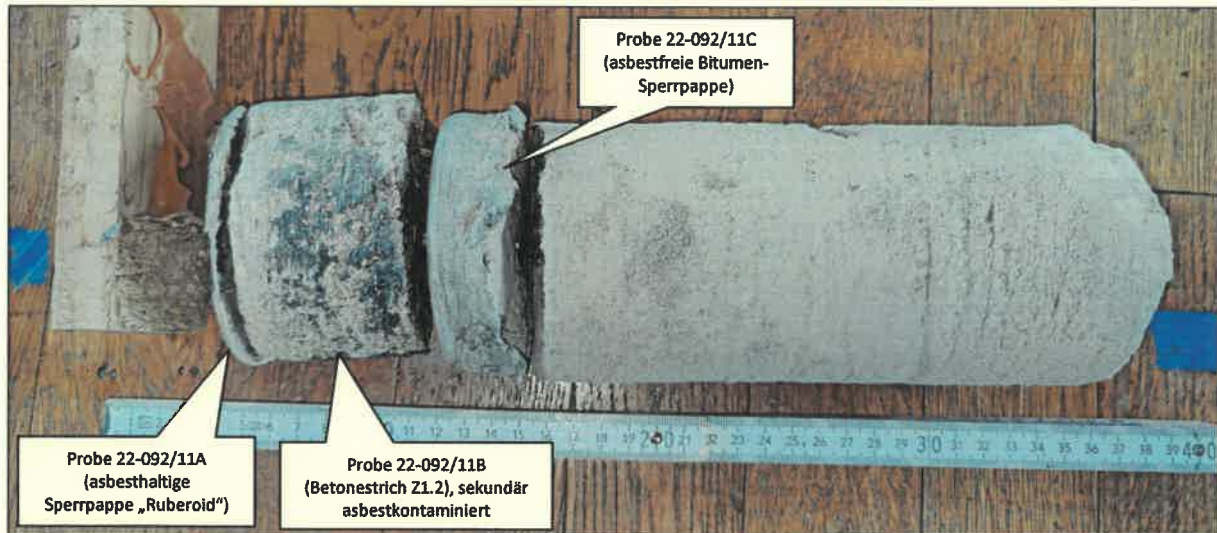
Zentraler Bereich, große Halle – Kernbohrung 22-092/11 zeigt Fußbodenaufbau mit Holzparkett über Lagerhölzer, asbesthaltiger Sperrpappe „Ruberoid“, asbestkontaminiertem Betonestrich Z 1.2, mehrlagigem Paket aus asbestfreien Bitumen-Sperrpappen und Rohbeton.
